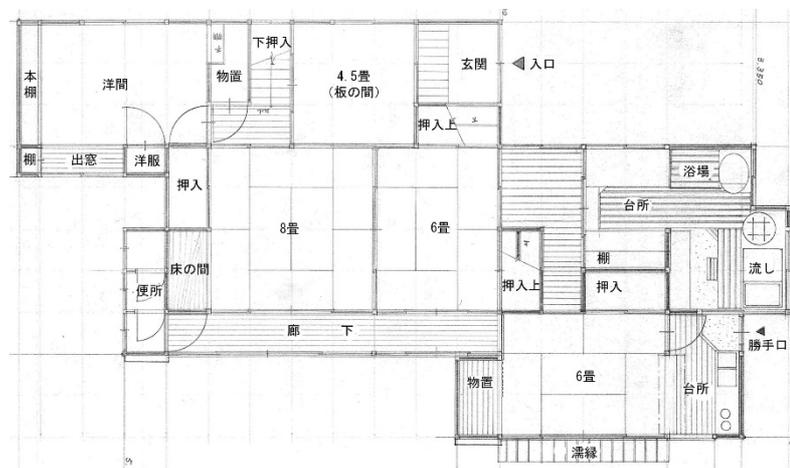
中原の生家と思われる配置図兼 1 階平面図
